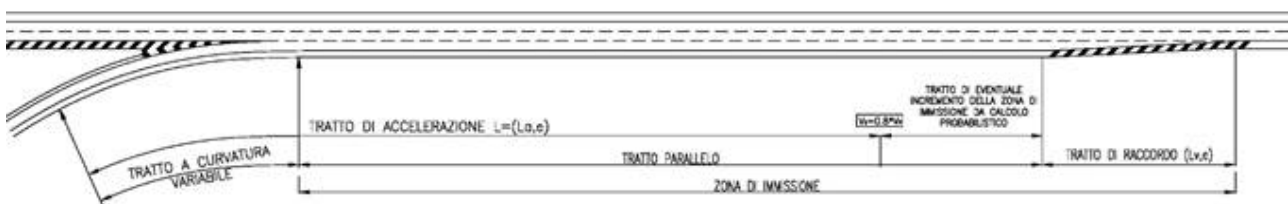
schema planimetrico corsia di ingresso (immissione)
